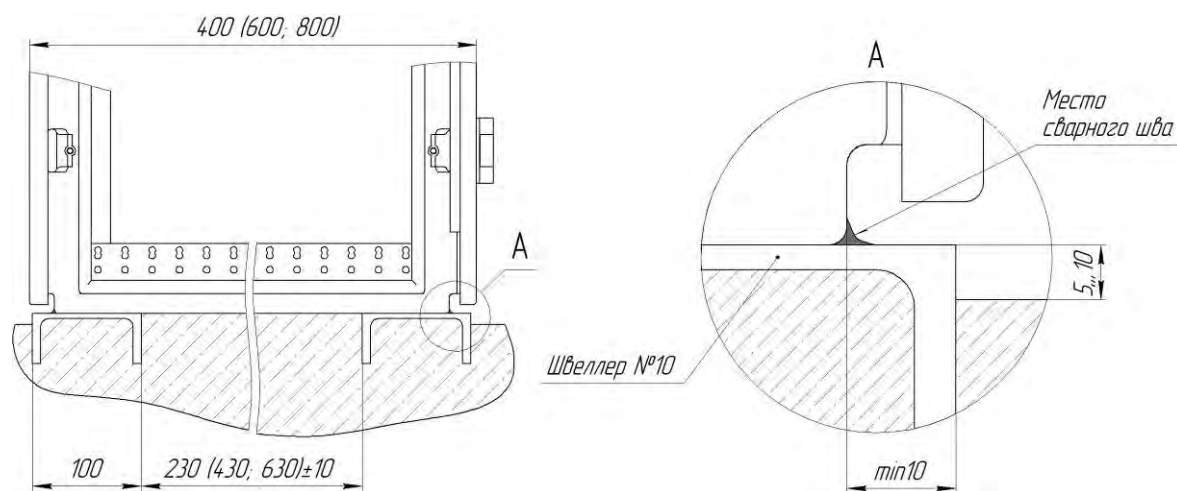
Крепление ШСП к закладным элементам при помощи сварки
